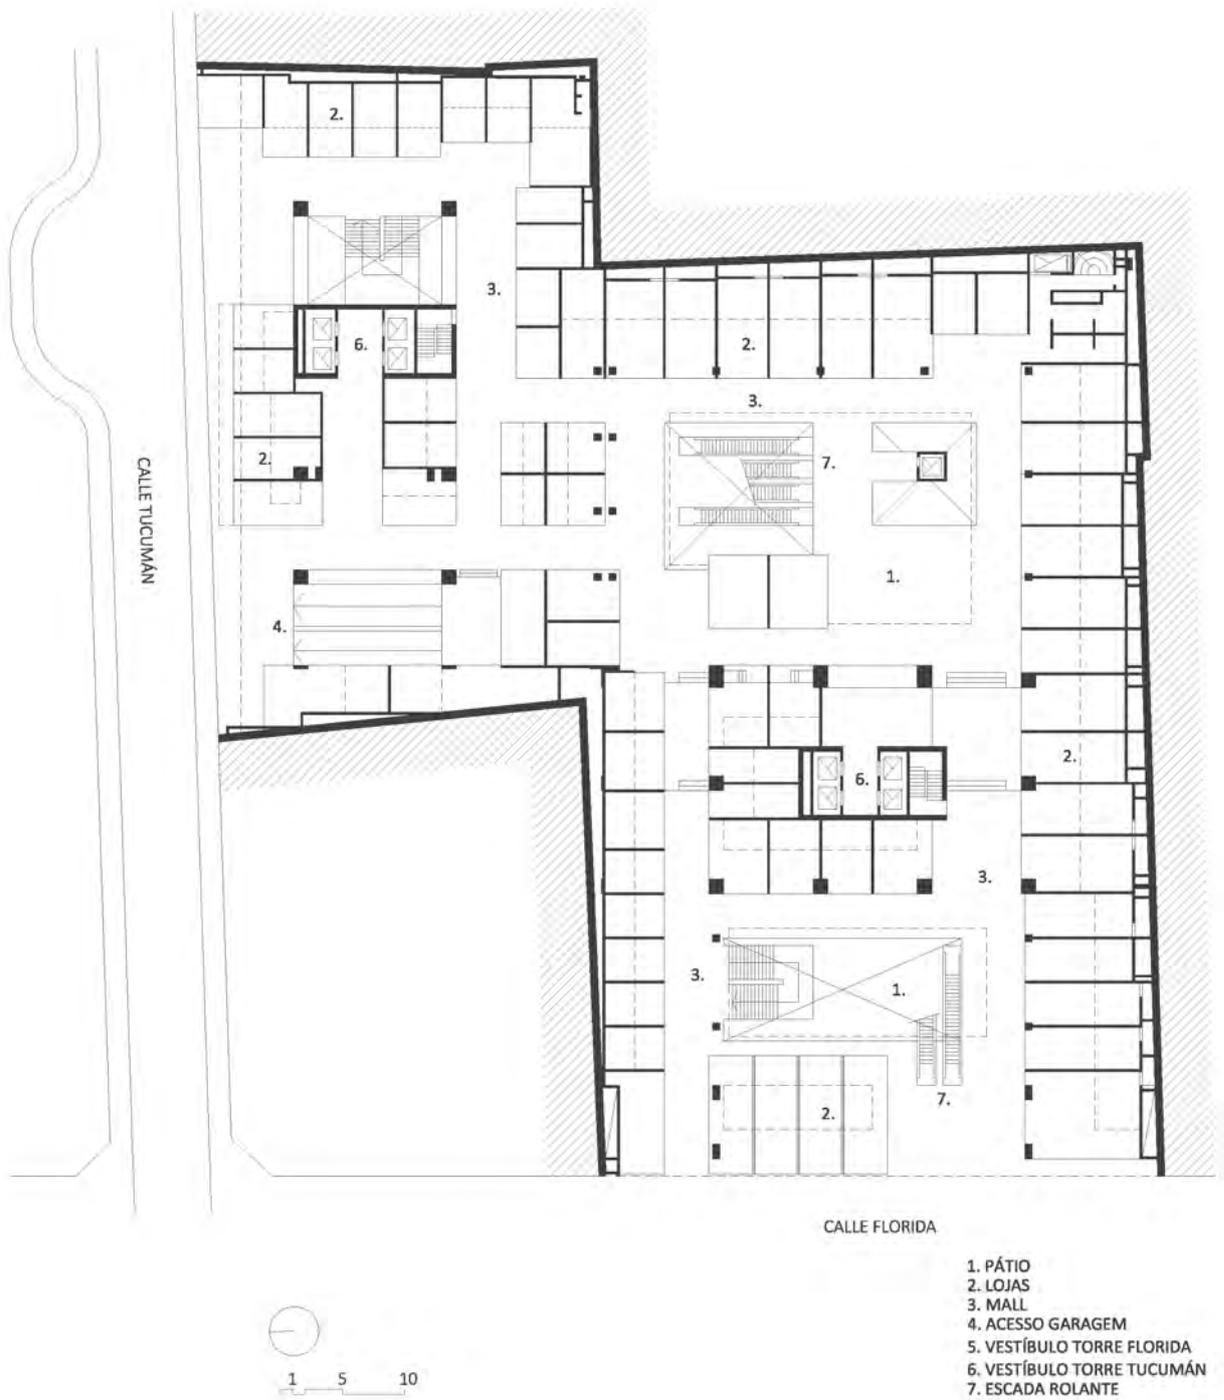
Planta Térrea, Galeria Jardín, 1974-1984.
